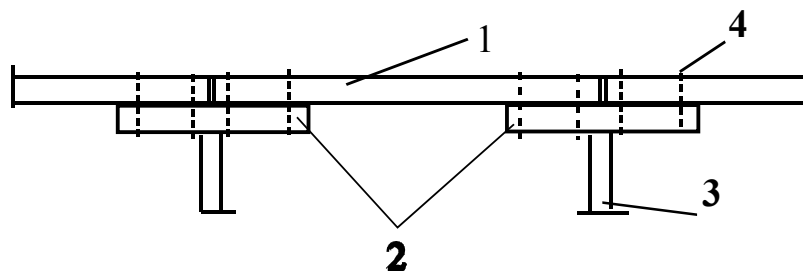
Балки (1), усиленные подбалками (2), 3- стойки; 4- болты
